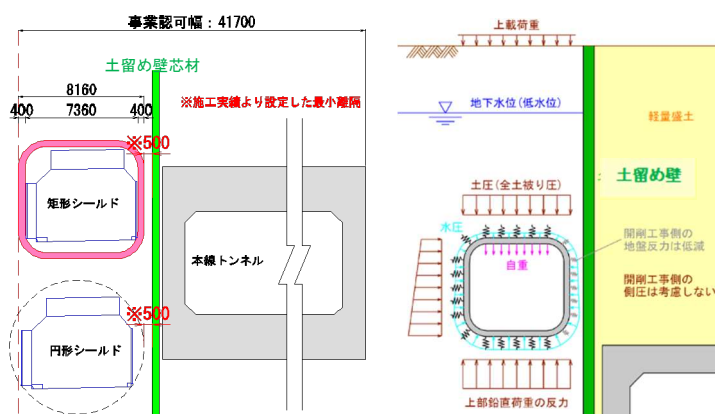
土留め壁併走区間断面図 図-8 設計荷重モデル図
